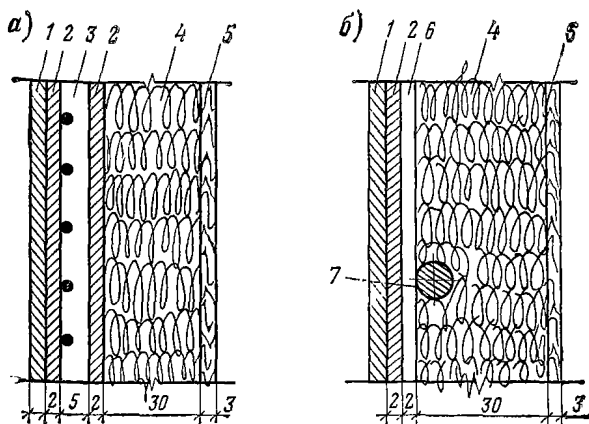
Схематический разрез щитов греющих опалубок с проволочным нагревателем (а) и с трубчатым электронагревателем (б)
